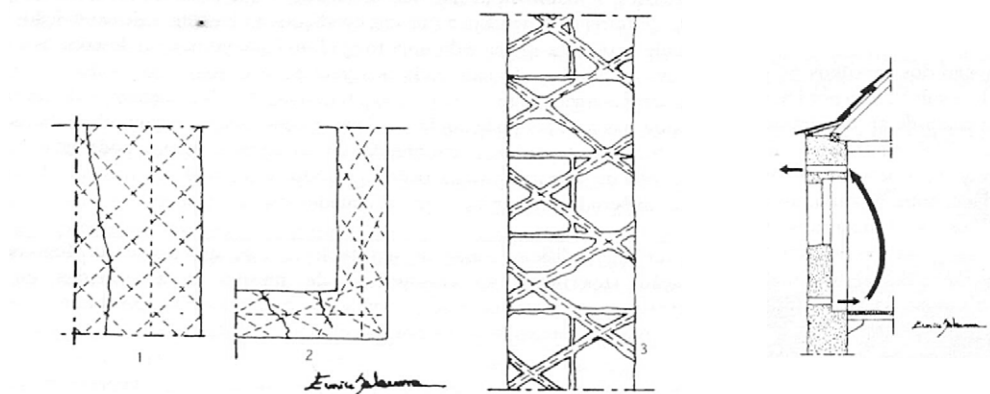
Reforço de alvenarias com “reticulado cementado”. (Três ilustrações à esq.) 1 - Vista frontal de cunhal. 2 - Planta de cunhal. 3 - Corte de parede.
